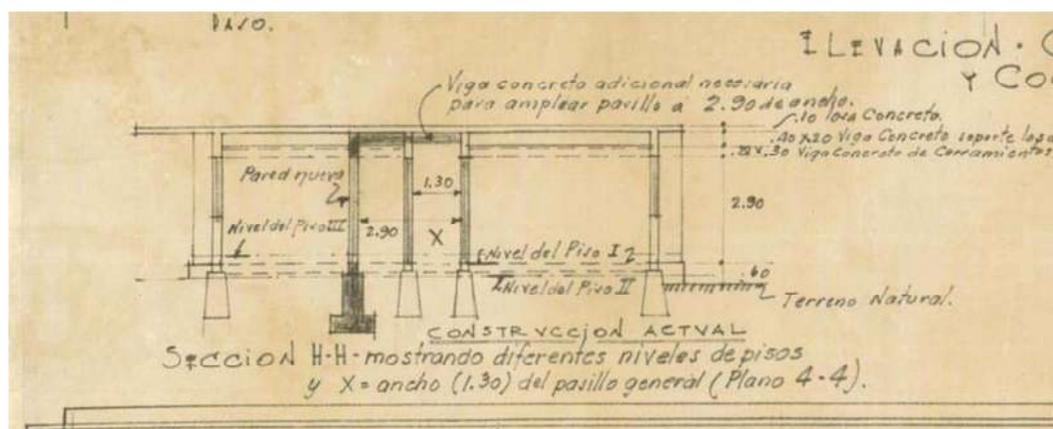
Sección de la casa hogar Soledad de Figaredo, donde se muestra el uso de cimientos de mampostería de piedra, a la par de cimientos de concreto reforzado. Plano cortesía de Catherine Ettinger.
